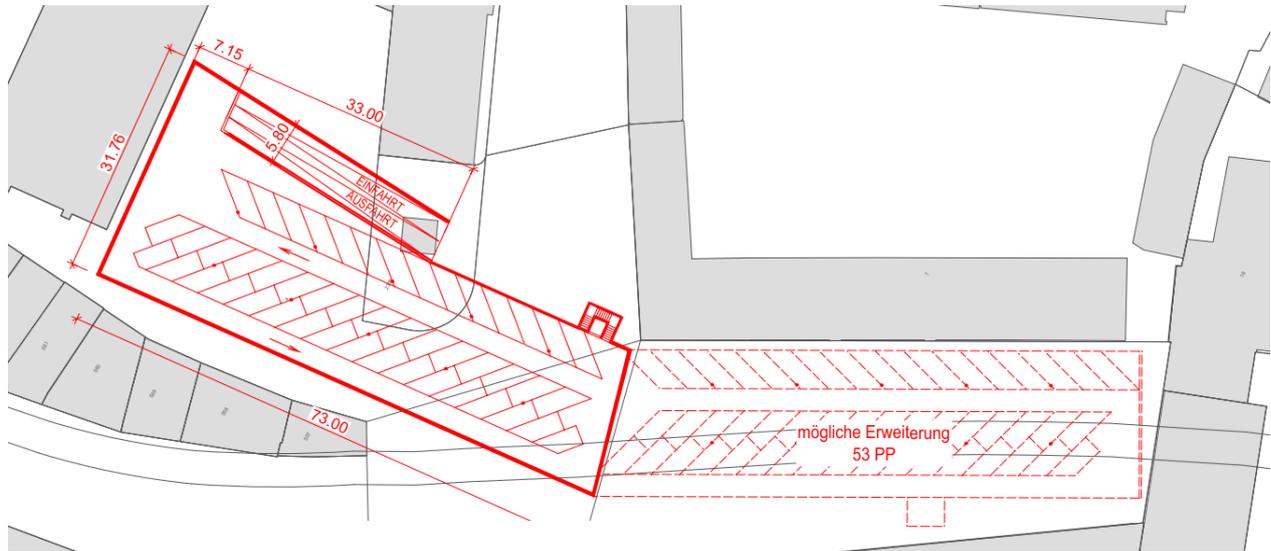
Ausschnitt Situation Variante Franziskaner 1.2 Grundriss Parkgeschoss
